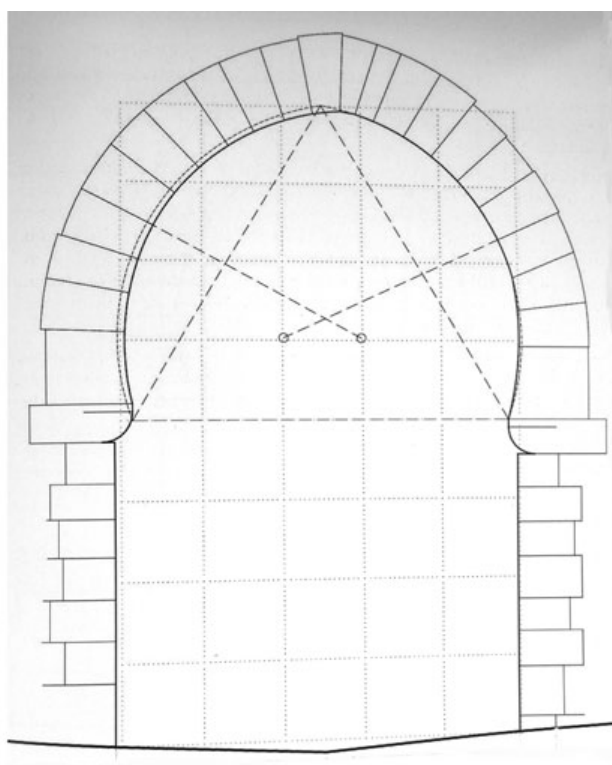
Plano de la entrada oeste de la puerta de la Imagen. Fuente: MURCIA ROSALES y MURCIA SERRANO. “La arquitectura musulmana en la Mota”, 598.
